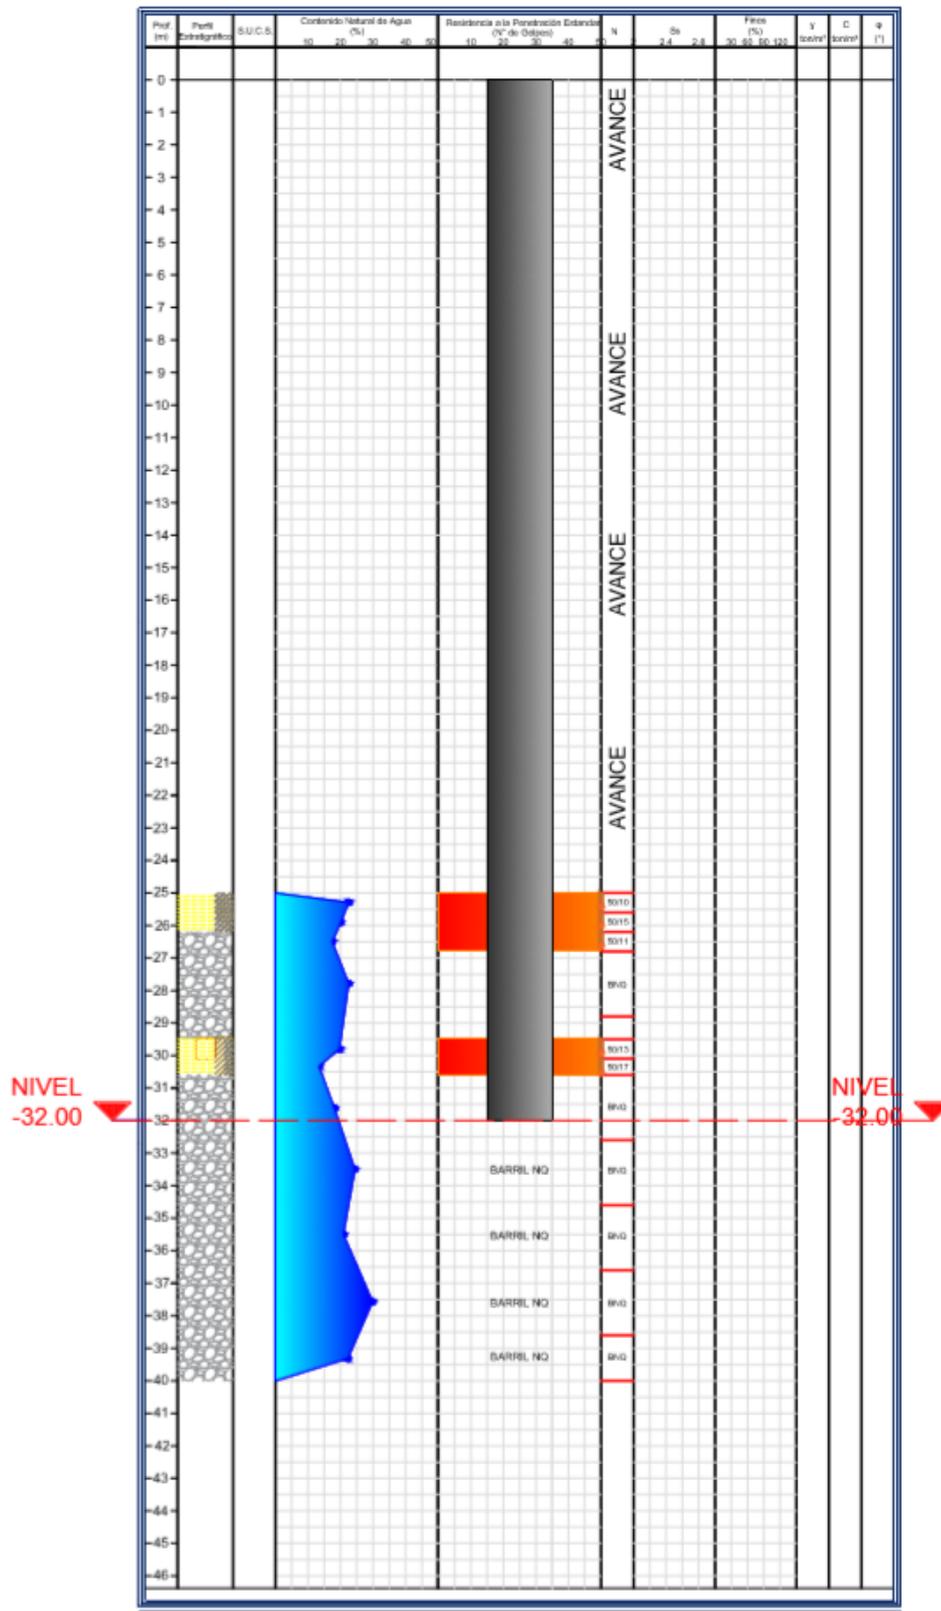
DESPLANTE DE PILA 19 (SM-11-EJE H3).
